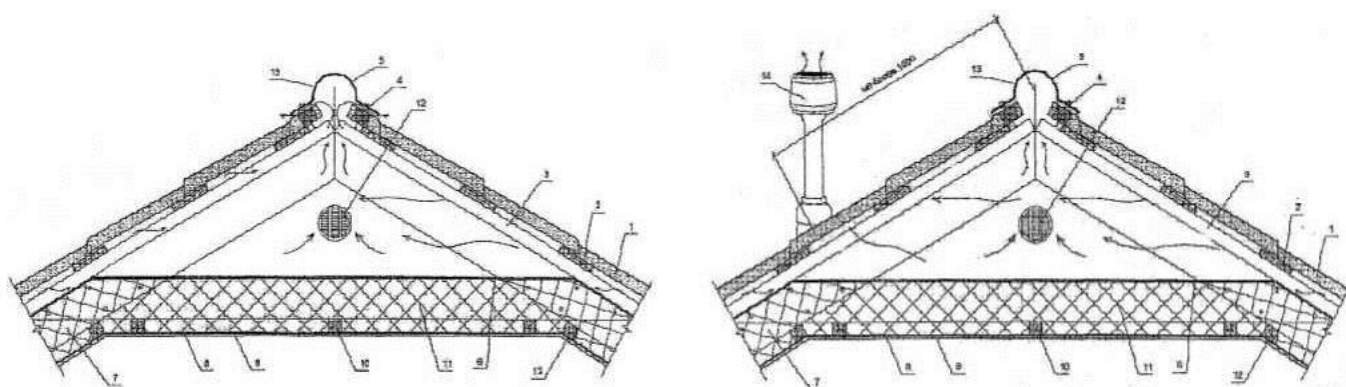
Коньковый узел кровли с вентиляцией через коньковый элемент (а) и через вытяжную трубу (б)
